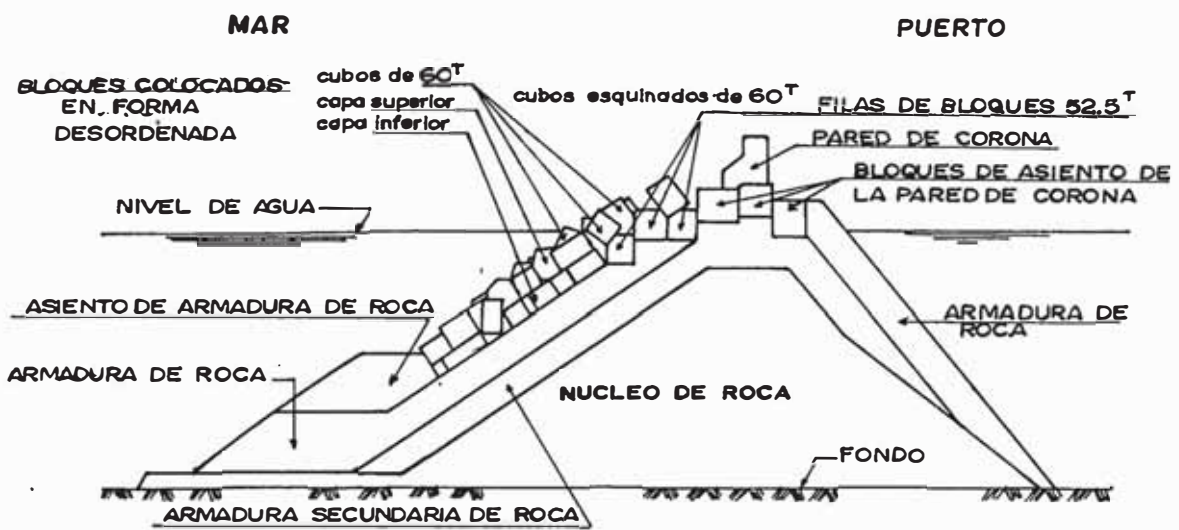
ROMPEOLAS ARMADO CON BLOQUES DE CONCRETO MONTADOS DE FORMA DESORDENADA ( PELL-MELL )
